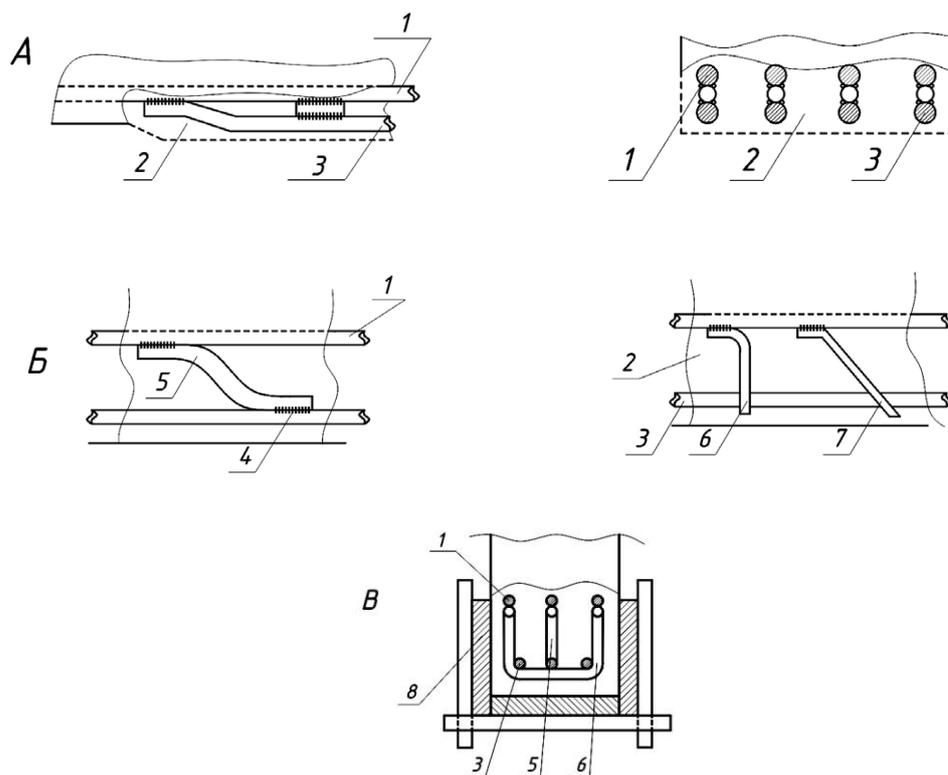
Усиление железобетонных балок добавочной арматурой: А – приварка дополнительной арматуры вблизи существующей; Б – приварка дополнительной арматуры с увеличением высоты балки; В – опалубка для бетонирования зоны усиления; 1 – существующая арматура; 2 – новый бетон зоны усиления; 3 – дополнительная арматура; 4 – сварка; 5 – наклонная дополнительная арматура; 6 – вертикальные хомуты; 7 – косые хомуты; 8 – опалубка для бетонирования зоны усиления
